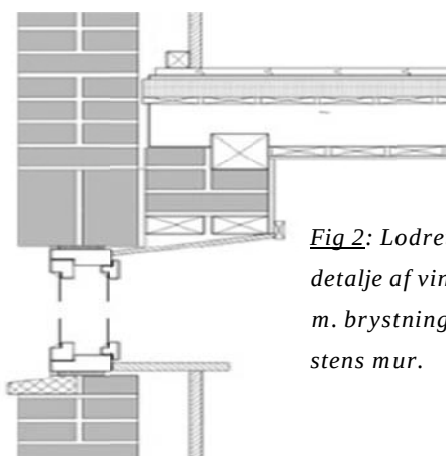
Lodret detalje af vindue m. brystning 1 stens mur.
